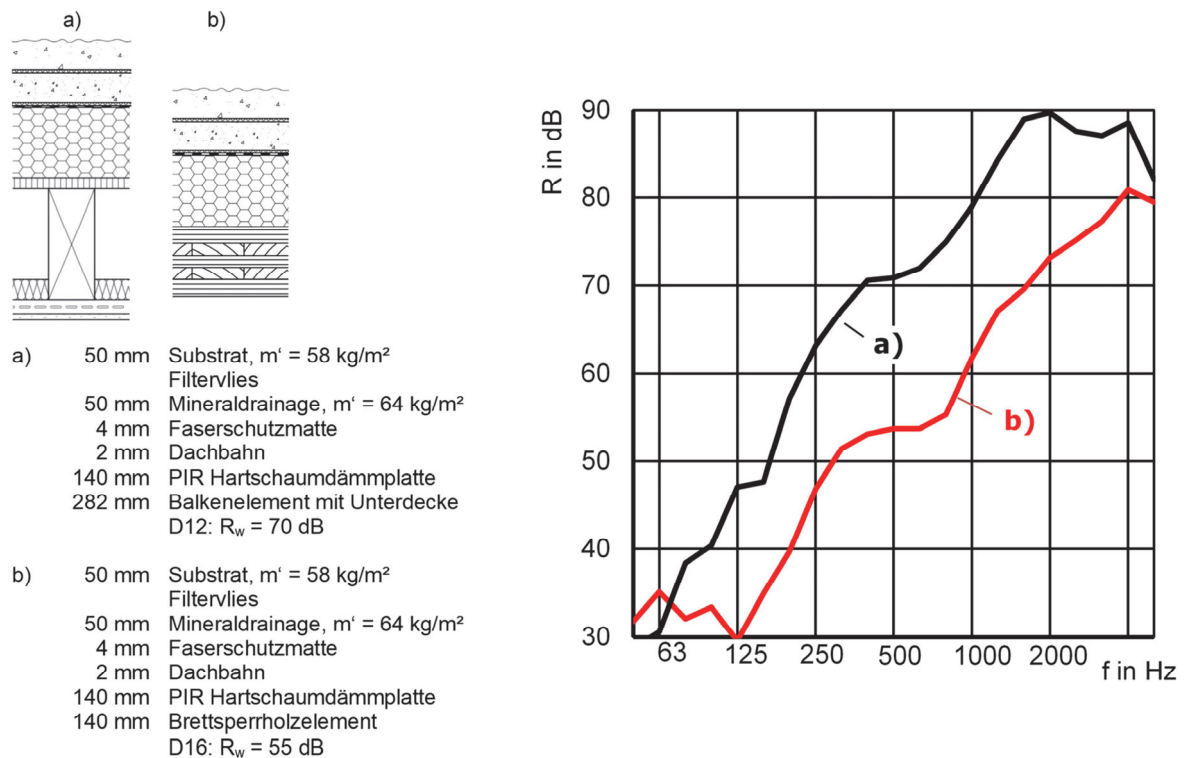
Gründachaufbau mit mineralischer Drainageebene auf Balkenelement und Massivholzelement
